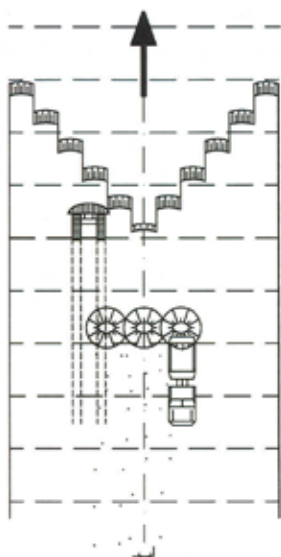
18 Fylling på geotekstil over bløt grunn.
